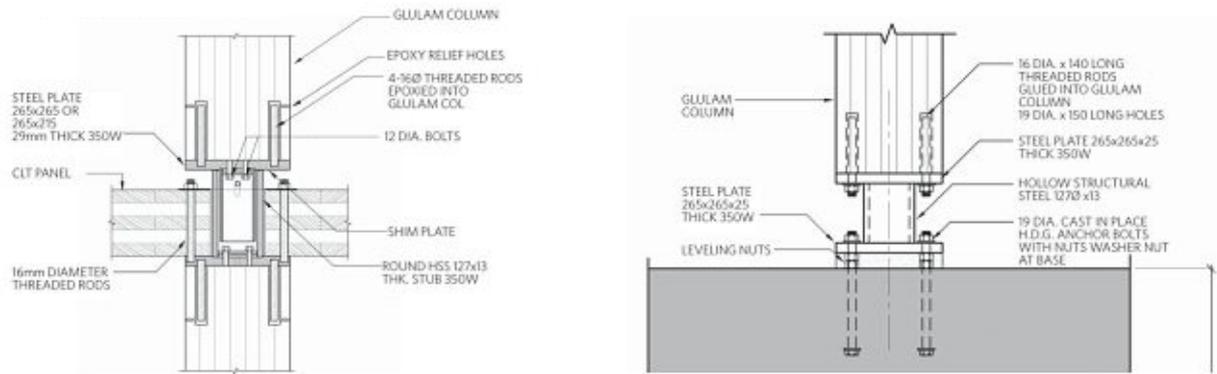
Anschlüsse zum Erdgeschoss und Regelgeschoss
